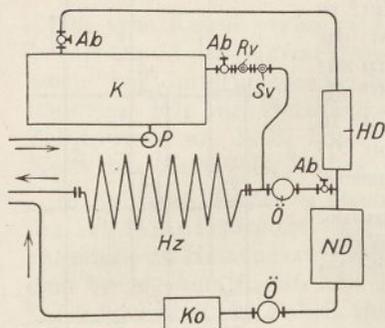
Hochdruckdampfheizung mit Zwischendampfenahme.
